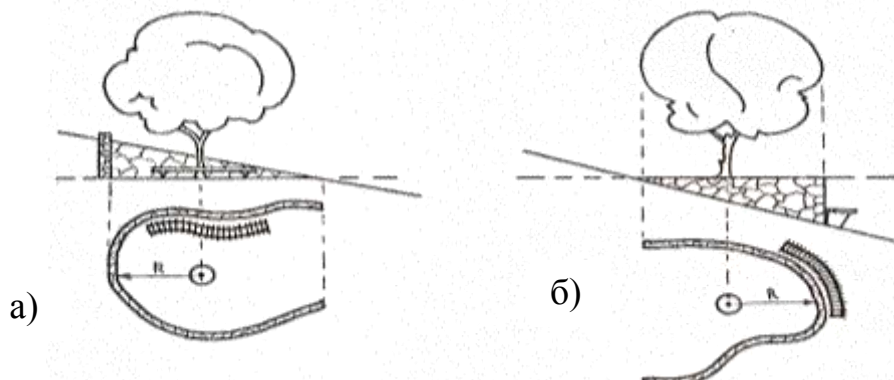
Улаштування підпірних стінок при збереженні зелених насаджень (план і розріз):
